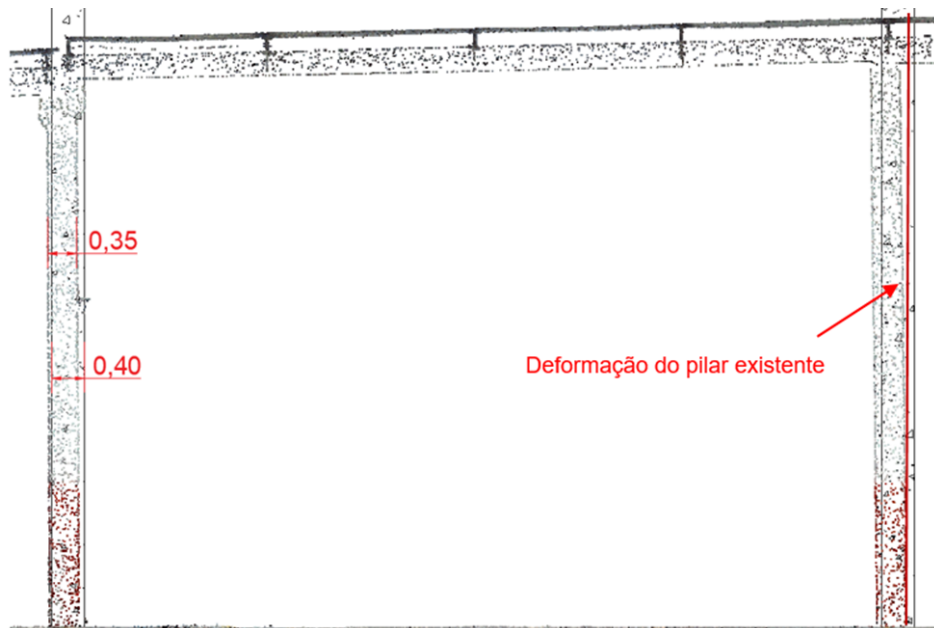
Comparação de secções dos pilares e deformações existentes
